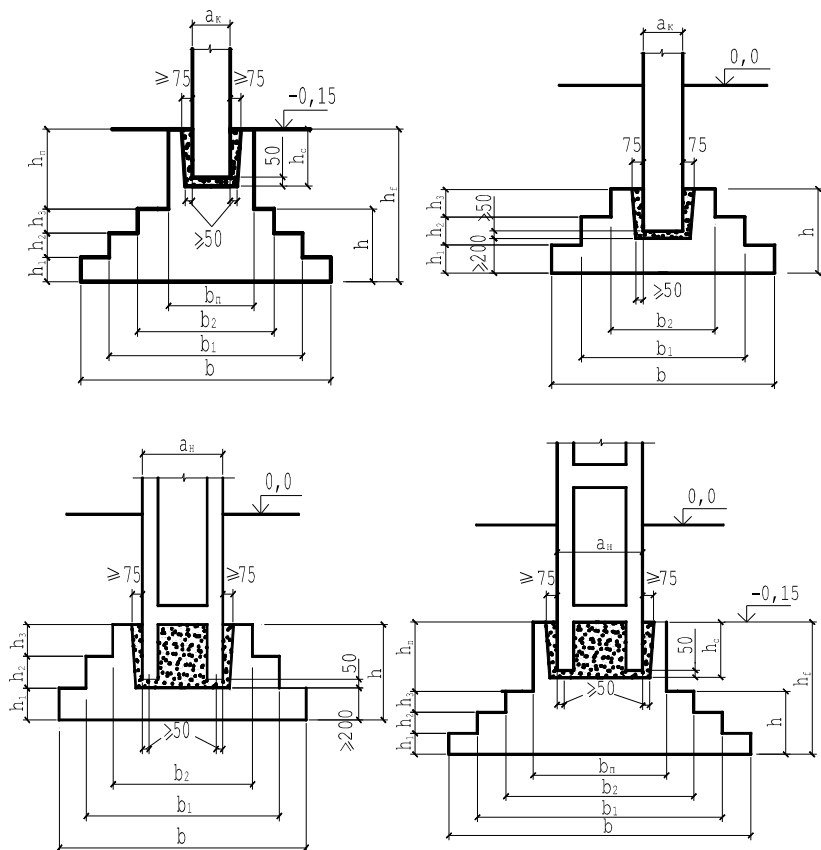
Фундаменты стаканного типа: а – под одноветвевую колонну; б – под одноветвевую колонну с повышенной стаканной частью; в – под двухветвевую колонну; г – под двухветвевую колонну с повышенной стаканной частью.
